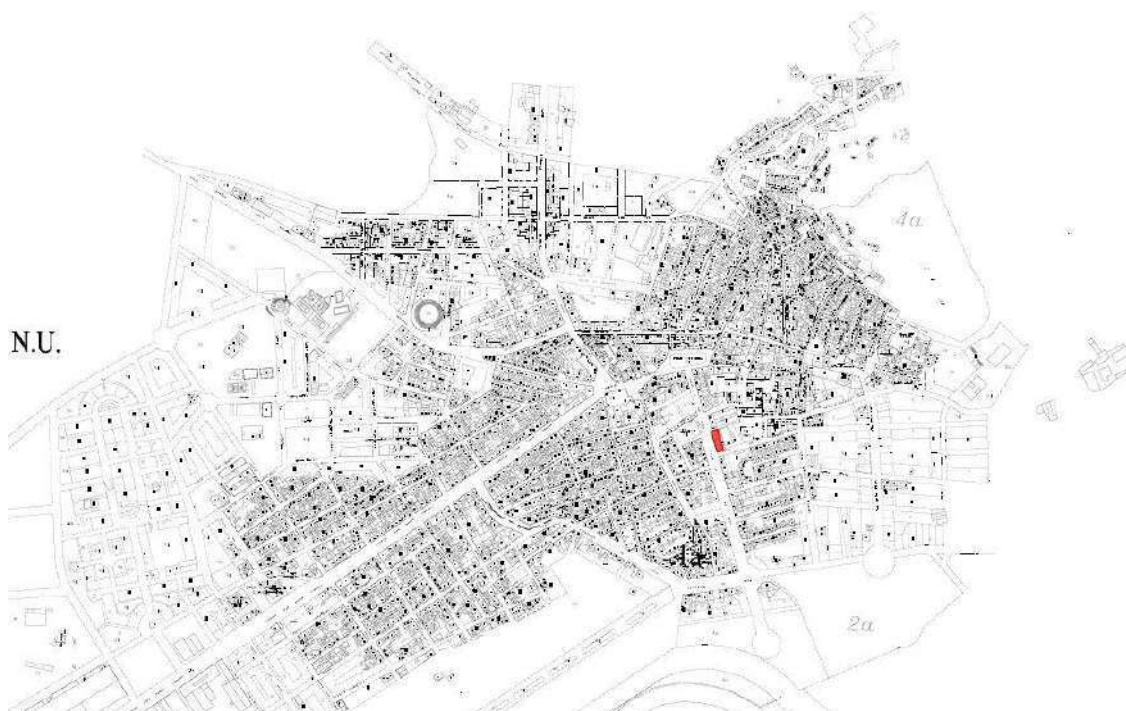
Plano de Situación. 2016. Fuente PGOU Calasparra.
